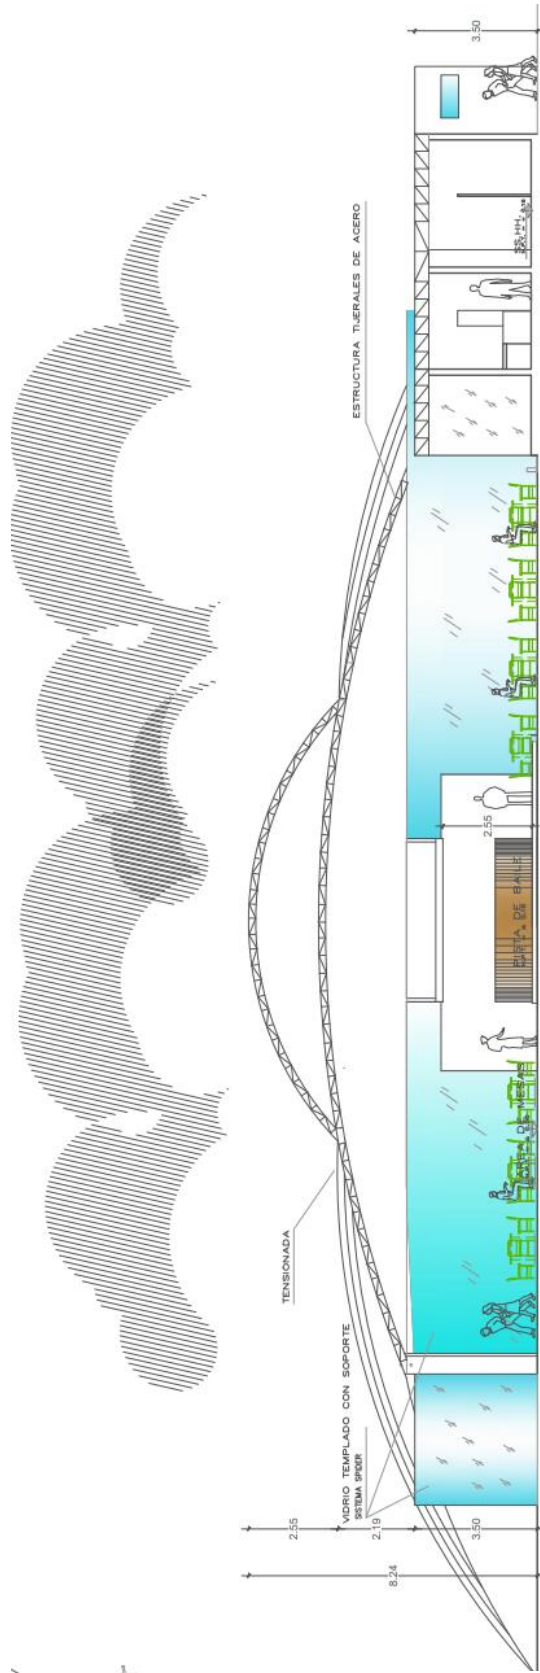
Plano restaurante – sector escogido - Elaboración propia.
